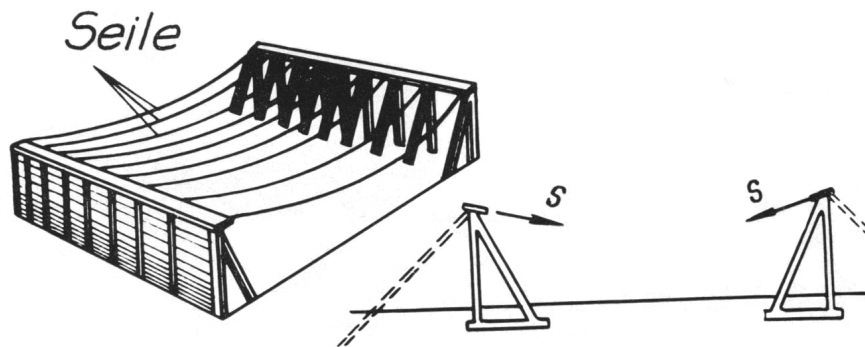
Lastableitung über Bockkonstruktionen [Rabinovič 1966]
